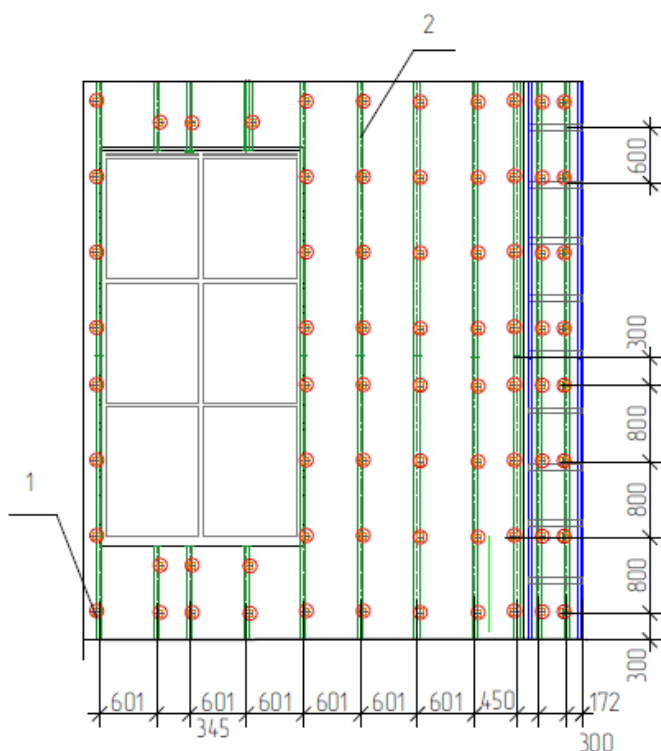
Схема крепления направляющей к кронштейну
